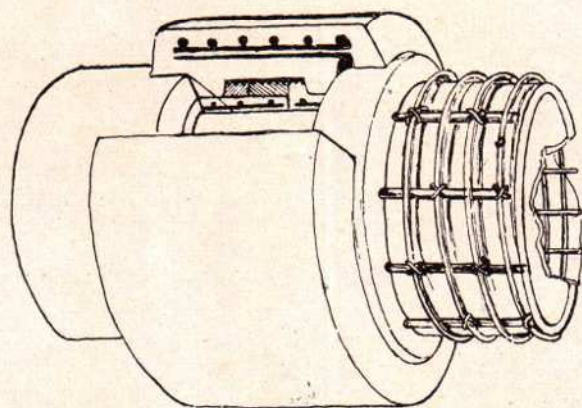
A — Tubos de aço soldado. B — Armaduras transversaes externas. C — Armaduras longitudinaes externas. D — Armaduras transversaes internas. E — Armaduras longitudinaes internas. F — Camada de protecção de concreto centrifugado. G — Camada de protecção de concreto vibrado
